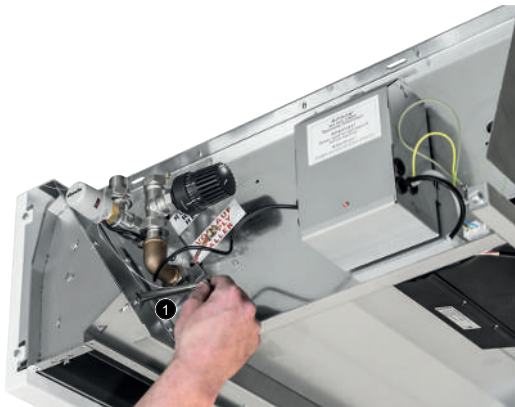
Fernfühler ① durch Kabeldurchführung führen.
